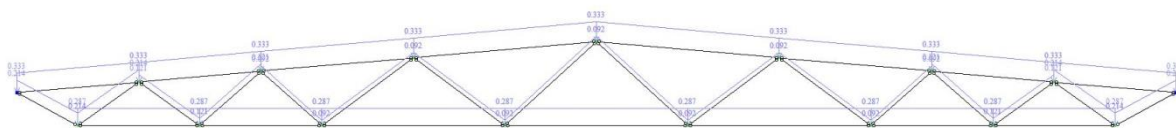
Расчетная схема фермы с нагрузкой от собственного веса
